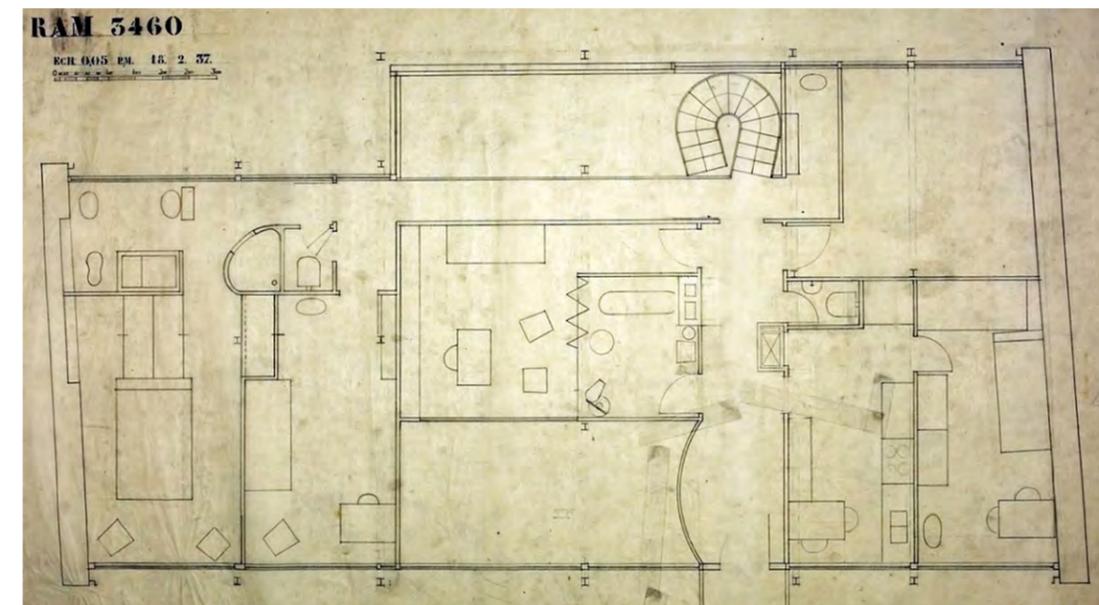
FLC 18555: Vivienda para el doctor Rameaux. Primer proyecto. Planta primera.
